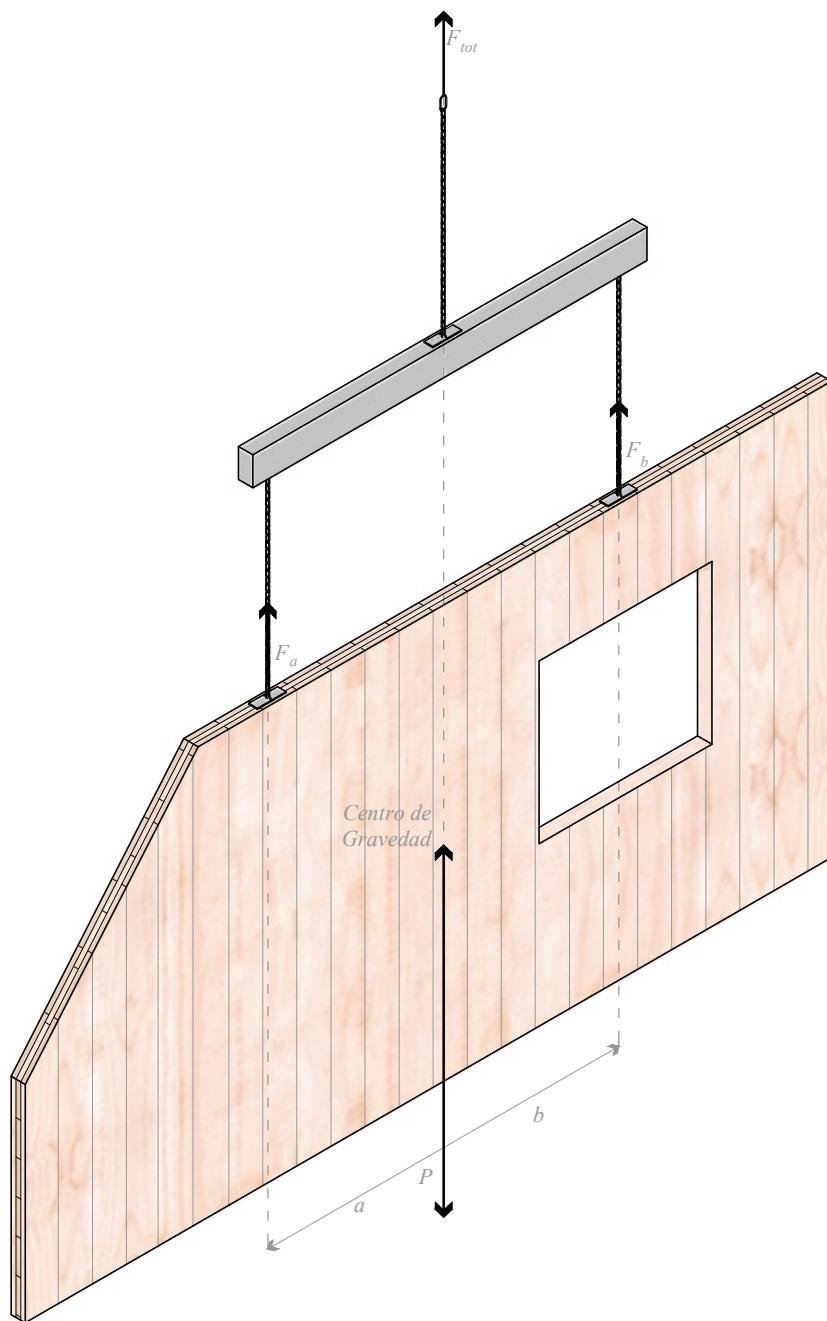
Distribución de fuerzas asimétrica en dos dispositivos de elevación para un panel izado con sistema separador.
